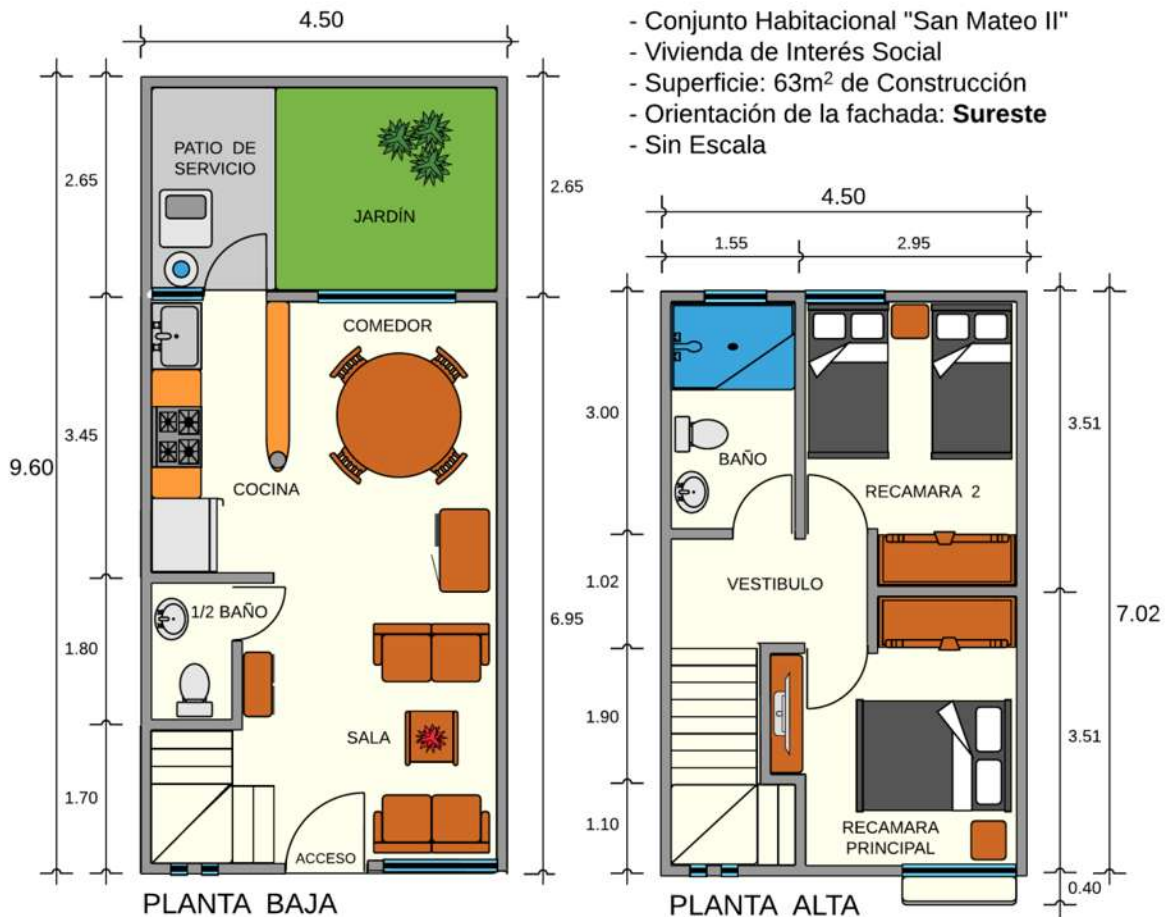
Plantas Arquitectónicas de la vivienda.
